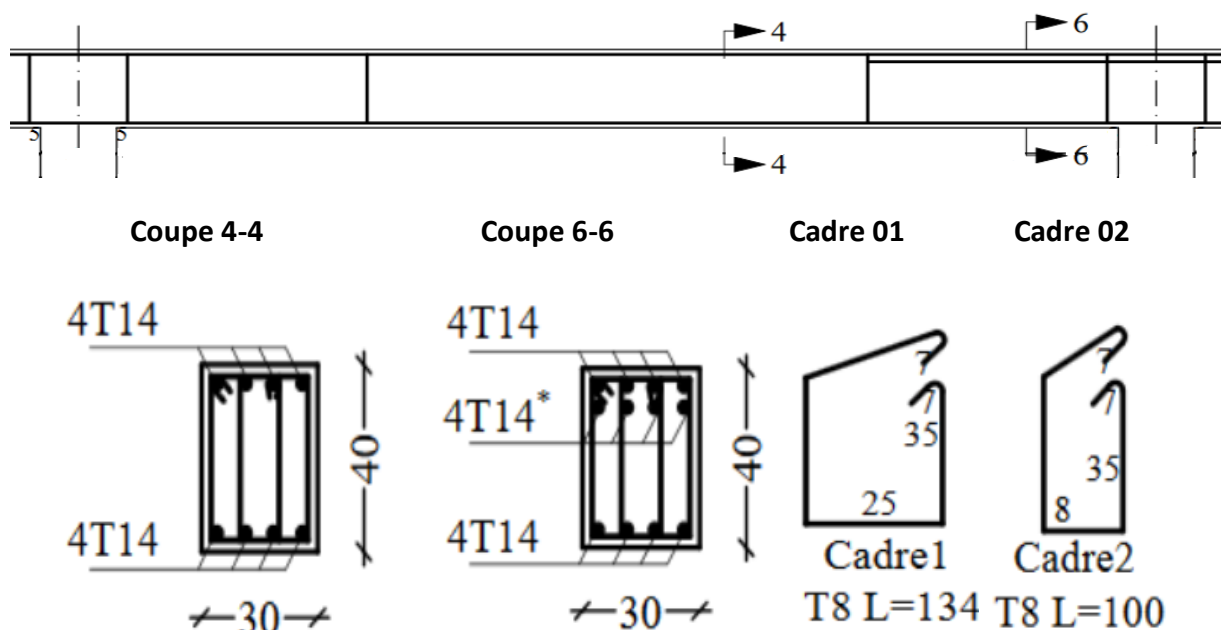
ferraillage de la poutre secondaire (30×40)
